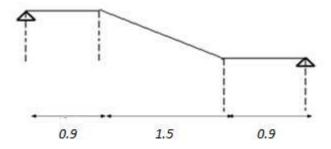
Un tronçon d'escalier de l'étage à deux paliers avec paillasse intermédiaire.
